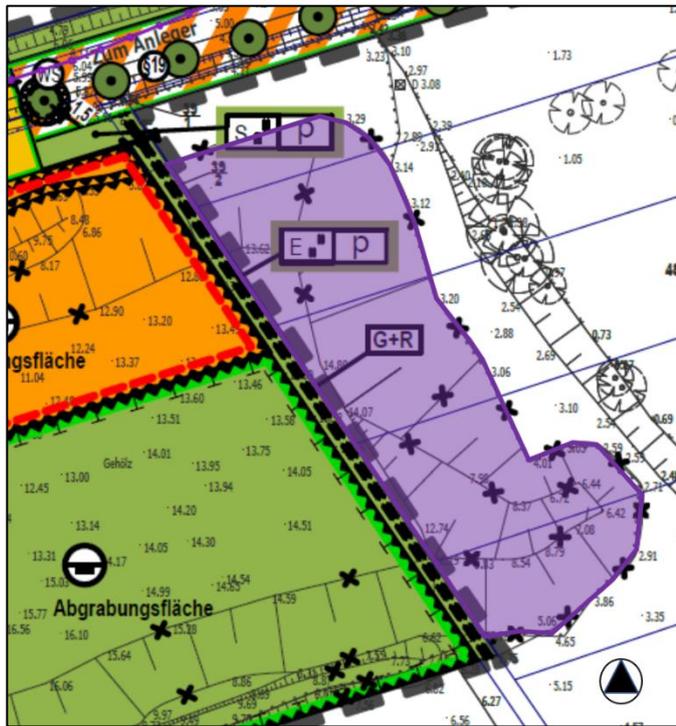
Angleichung des Geländes außerhalb des Plangebietes (lila gekennzeichnete Fläche); Kartengrundlage: Auszug Planzeichnung, Stand: Beschlussvorlage Satzung – Bearbeitungsstand 25.Mai 2018
